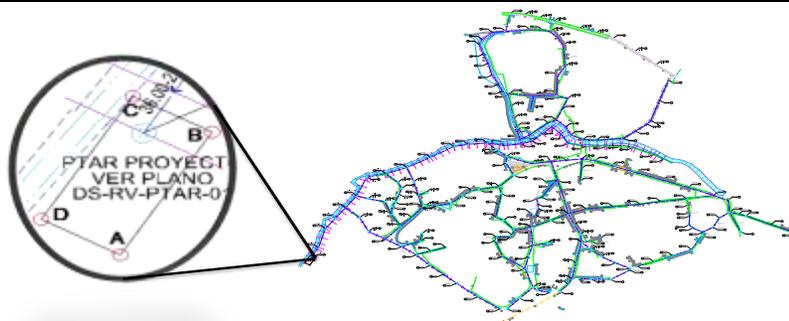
CROQUIS DEL PROYECTO
